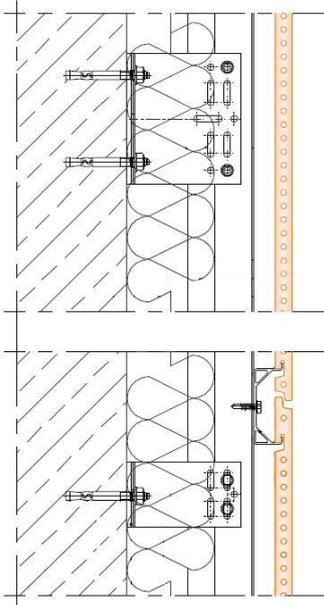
Sección vertical. FAVEKER® FV. Sistema perfil horizontal.
